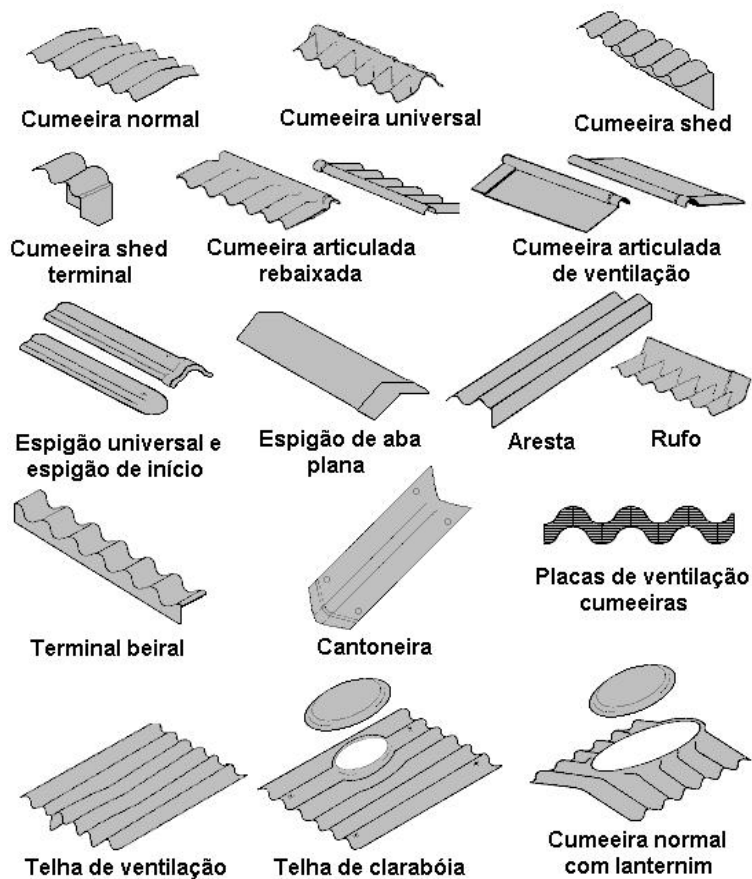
Peças complementares para telhados com telhas “Onduladas”
